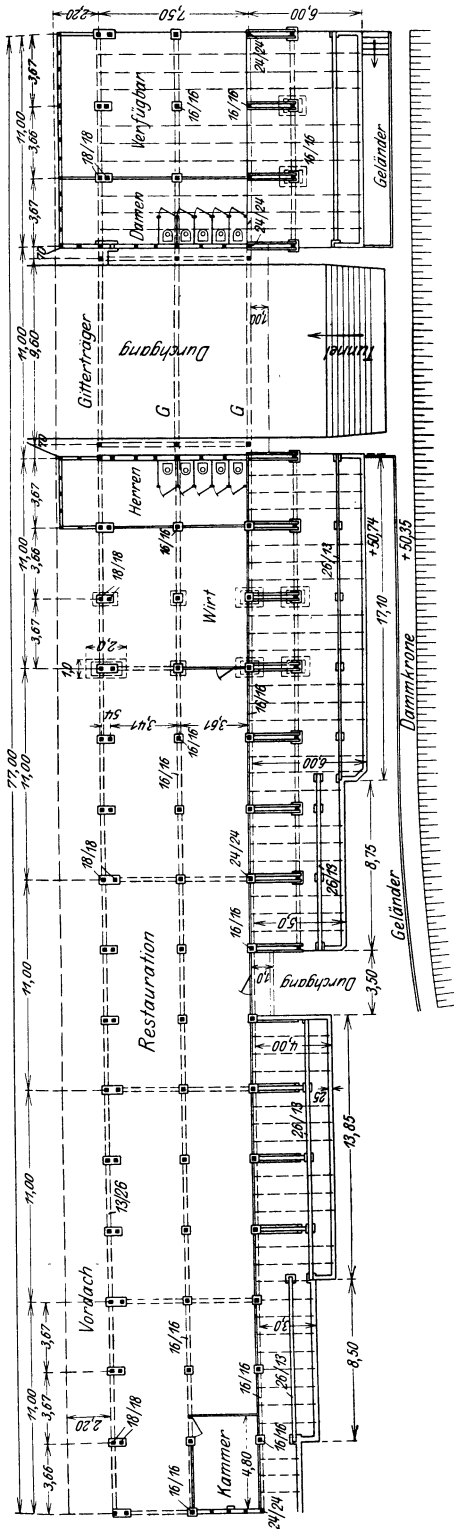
Grundriß des Untergeschosses der Tribüne A.
